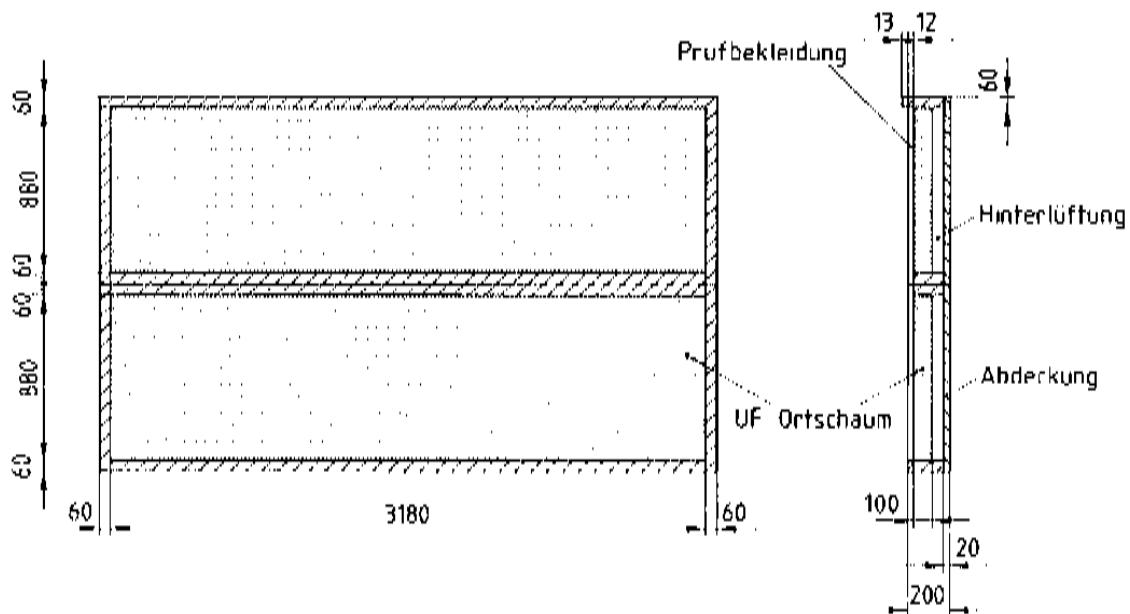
Dachraumkonstruktion für die Prüfraumuntersuchung von UF-Ortschaum (Maße in mm)
